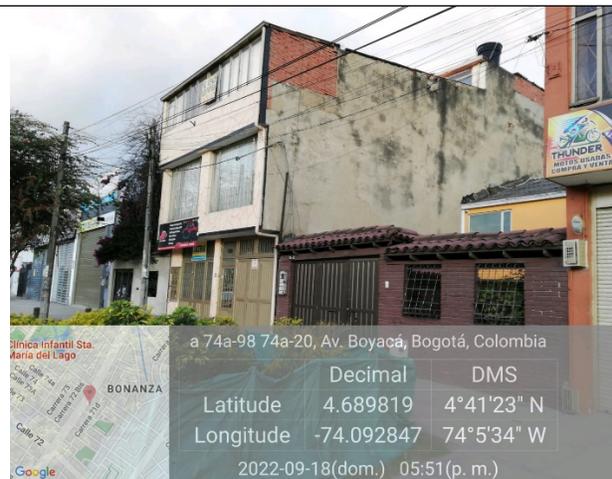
Vista del panel orientación Sur-Norte y de la estructura de la valla, en buenas condiciones y estable.
